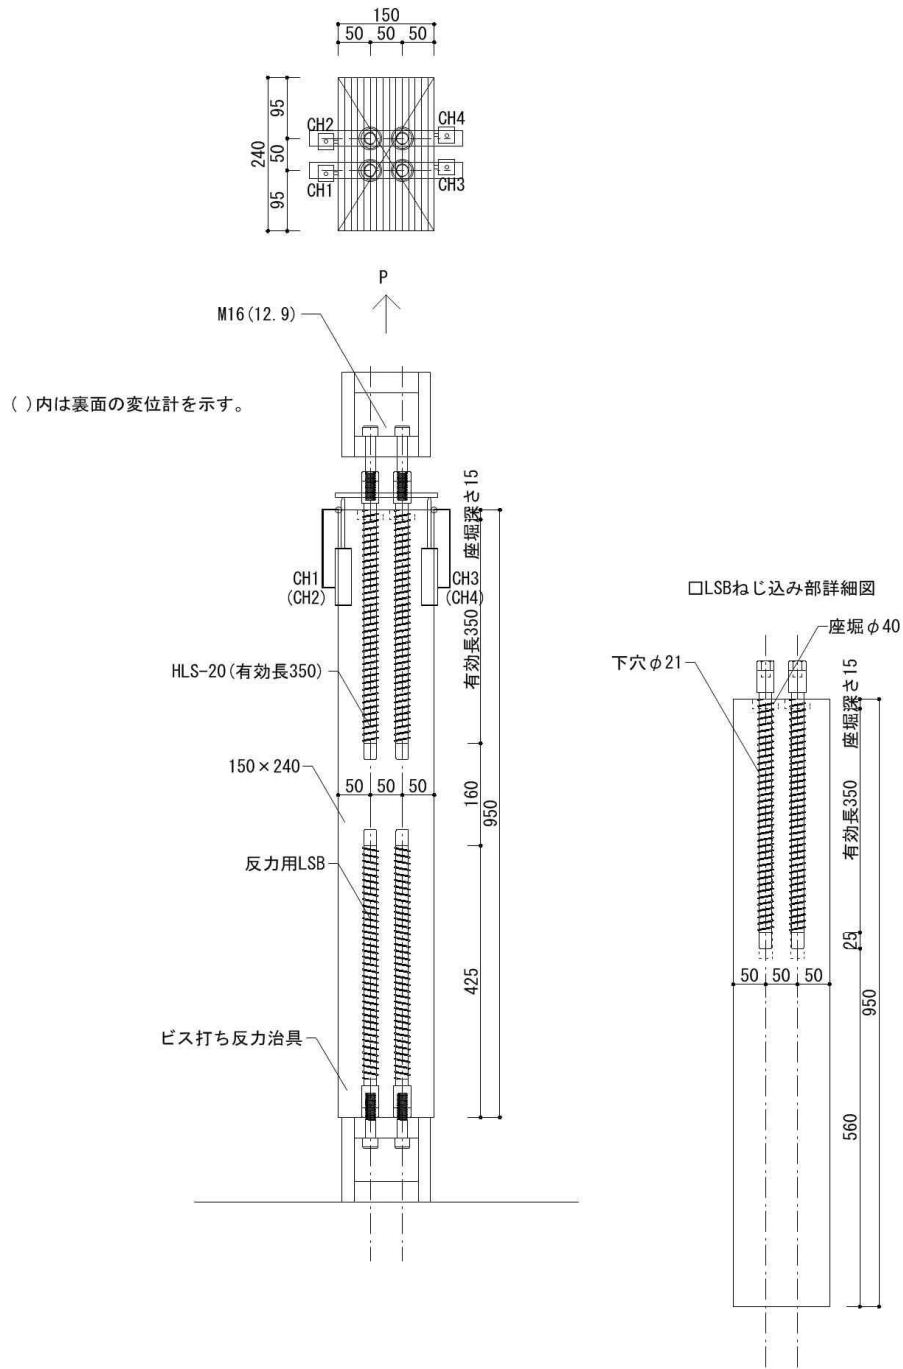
試験体の形状及び寸法 (B-3)
